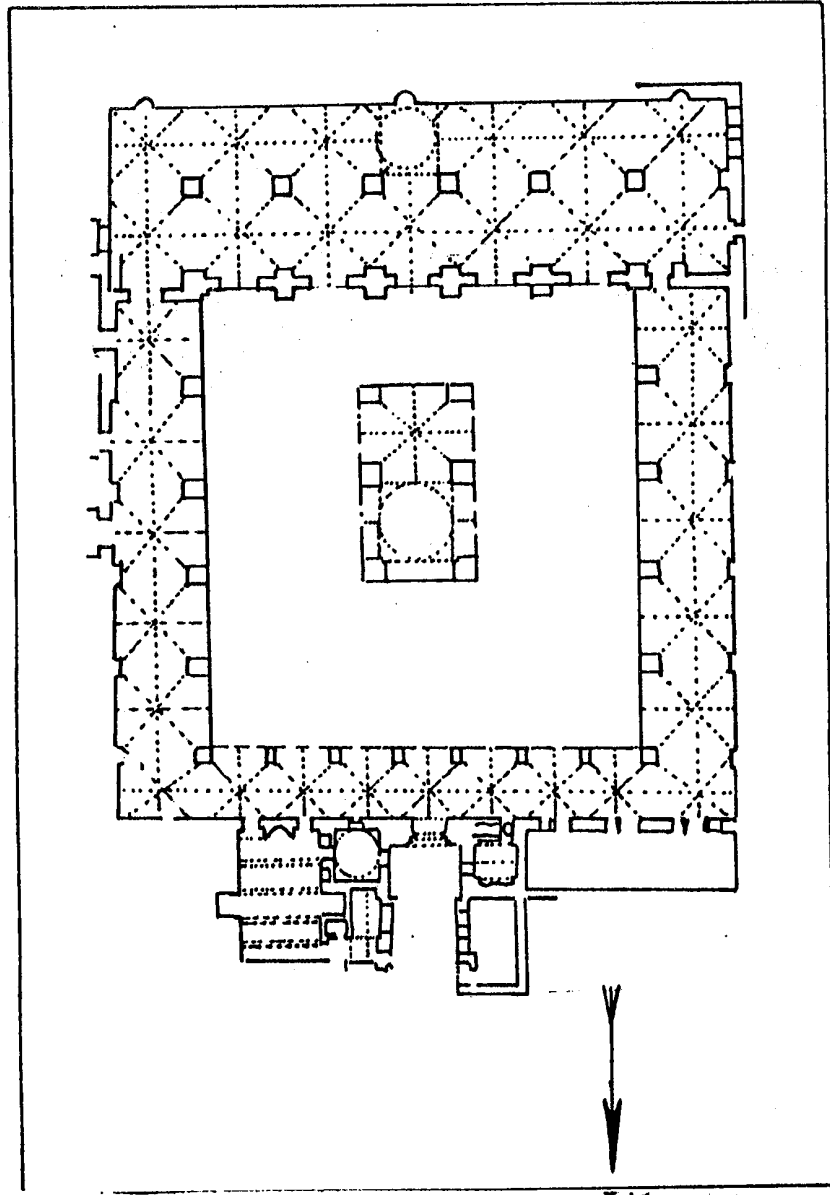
مسقط أفقي للجامع الازهر في مرحلة إنشائه الاولى بالقاهرة (عن : Hoag)
